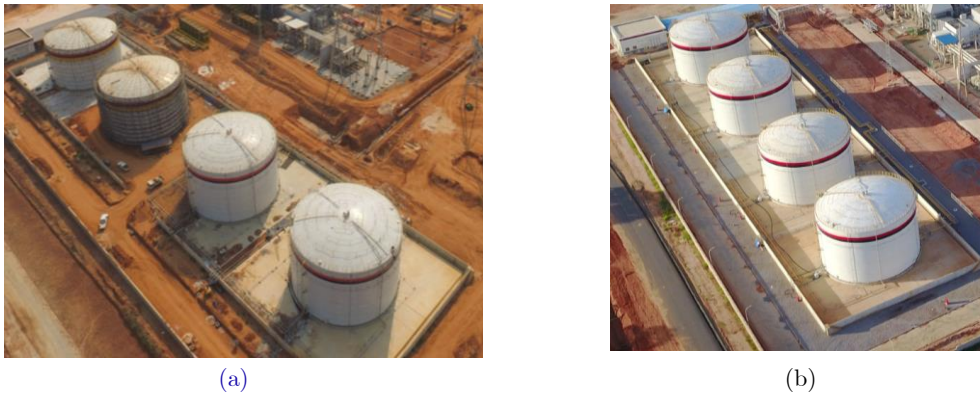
(a) Construcao faseada do pavimento da CCC do Soyo; (b) Aspetto final da bacia de retencao da CCC do Soyo.
